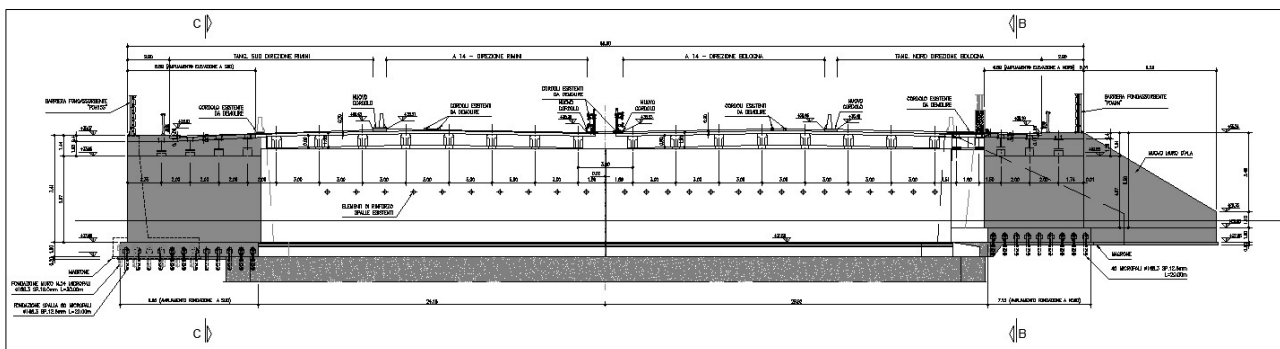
Prospetto Spalla Bologna con ampliamenti
